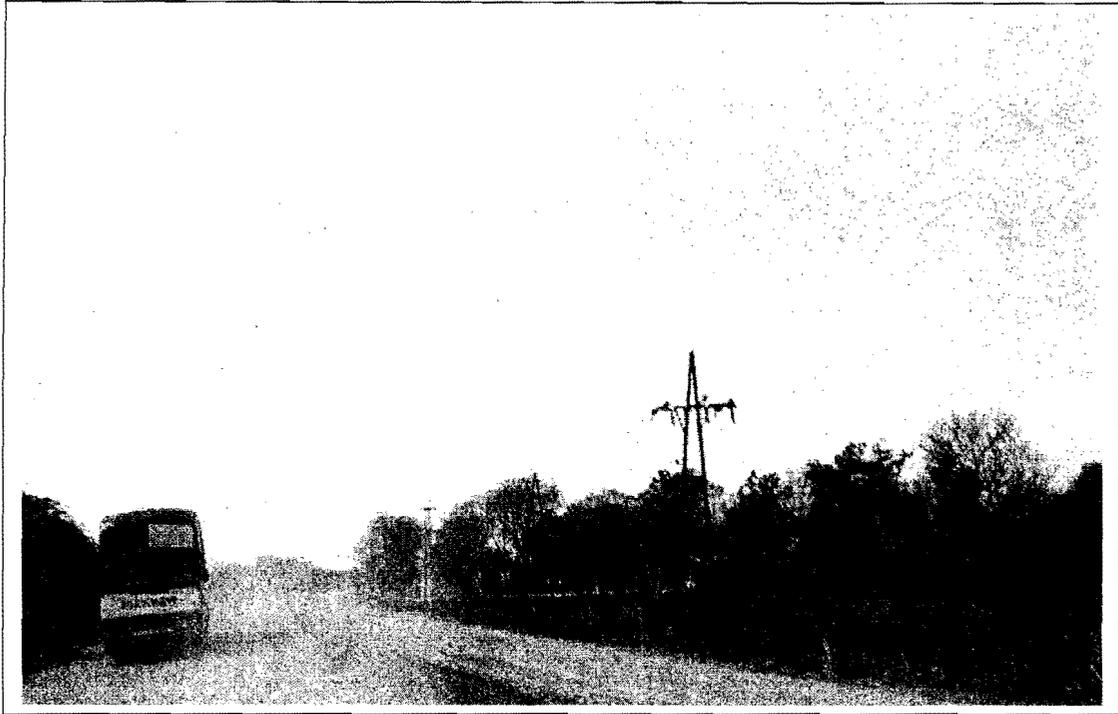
Colectivo sobre la RP N° 3 en el acceso a Fortín Lavalle.
